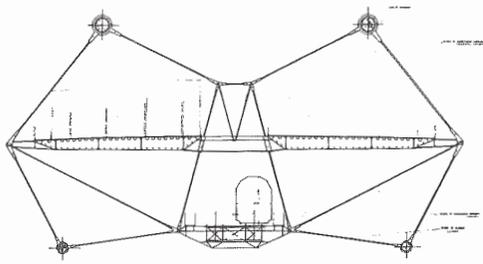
Ponte sullo stretto di Messina, sezione dell'impalcato
